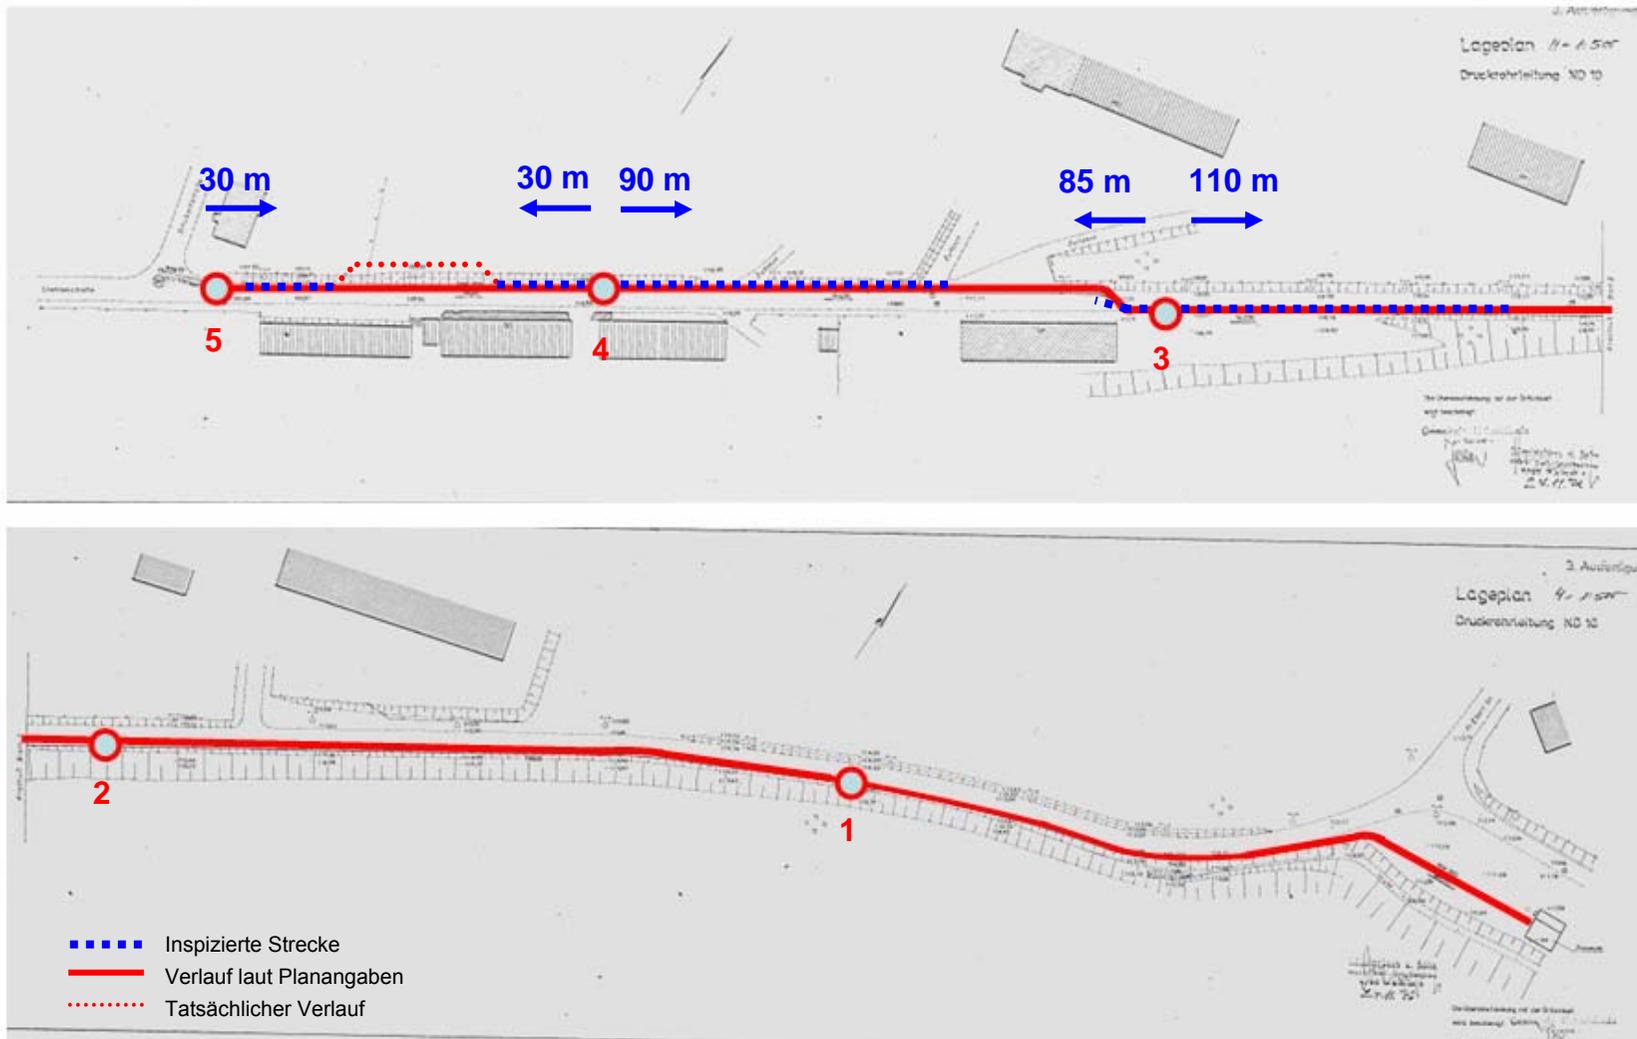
Lageplan Druckleitung Guss DN 300, Länge rund 800 m
